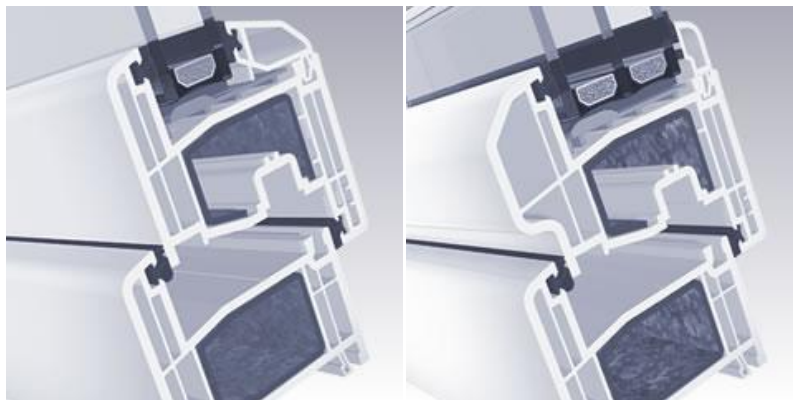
Profilsystem S 8000 IQ mit 5 Kammern; links: Zweifach-Wärmeschutzverglasung und flächenversetzte Ausführung mit zweifach abgeschrägter Glasleiste; rechts: Dreifach-Wärmeschutzverglasung und halbflächenversetzte Ausführung mit runder Glasleiste
